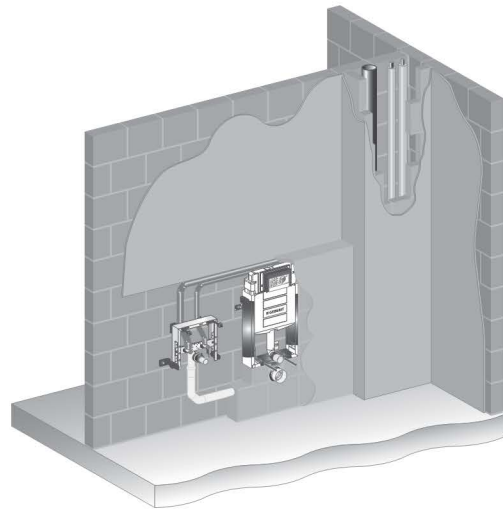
Geberit GIS Installationssystem Trennwandinstallation
